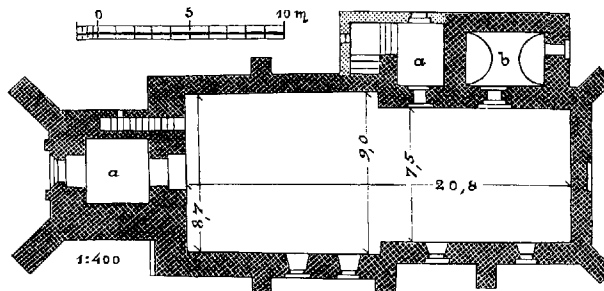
Gr. Tromnau. Grundriss der Kirche.
